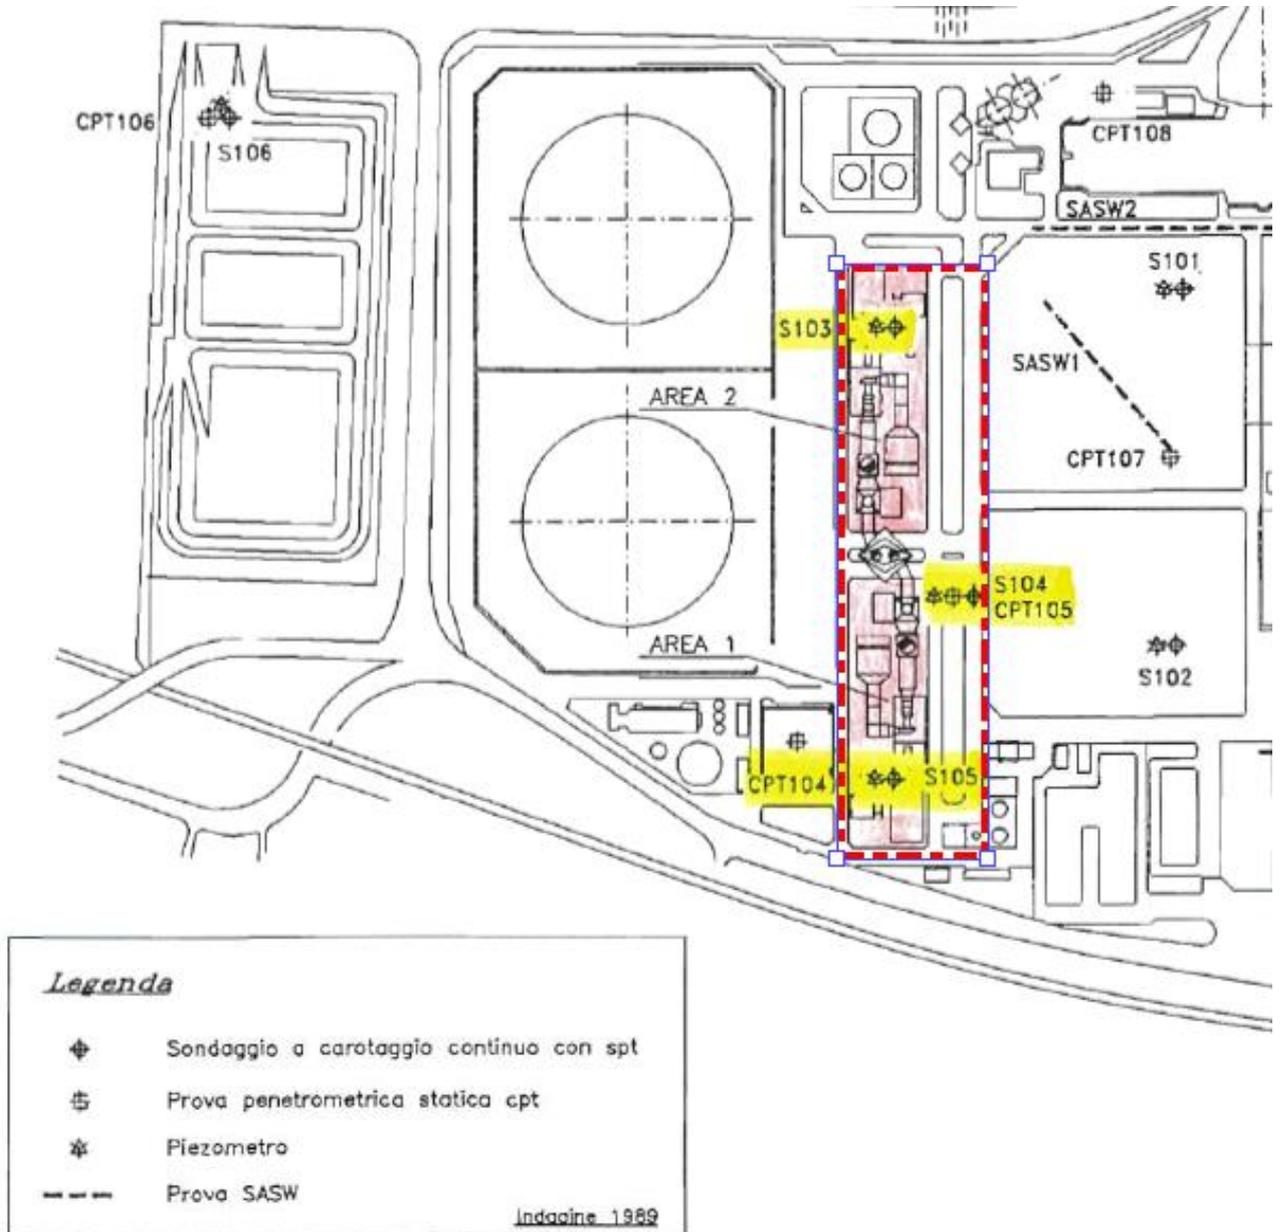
Planimetria con posizione sondaggi disponibili nell’area di intervento
